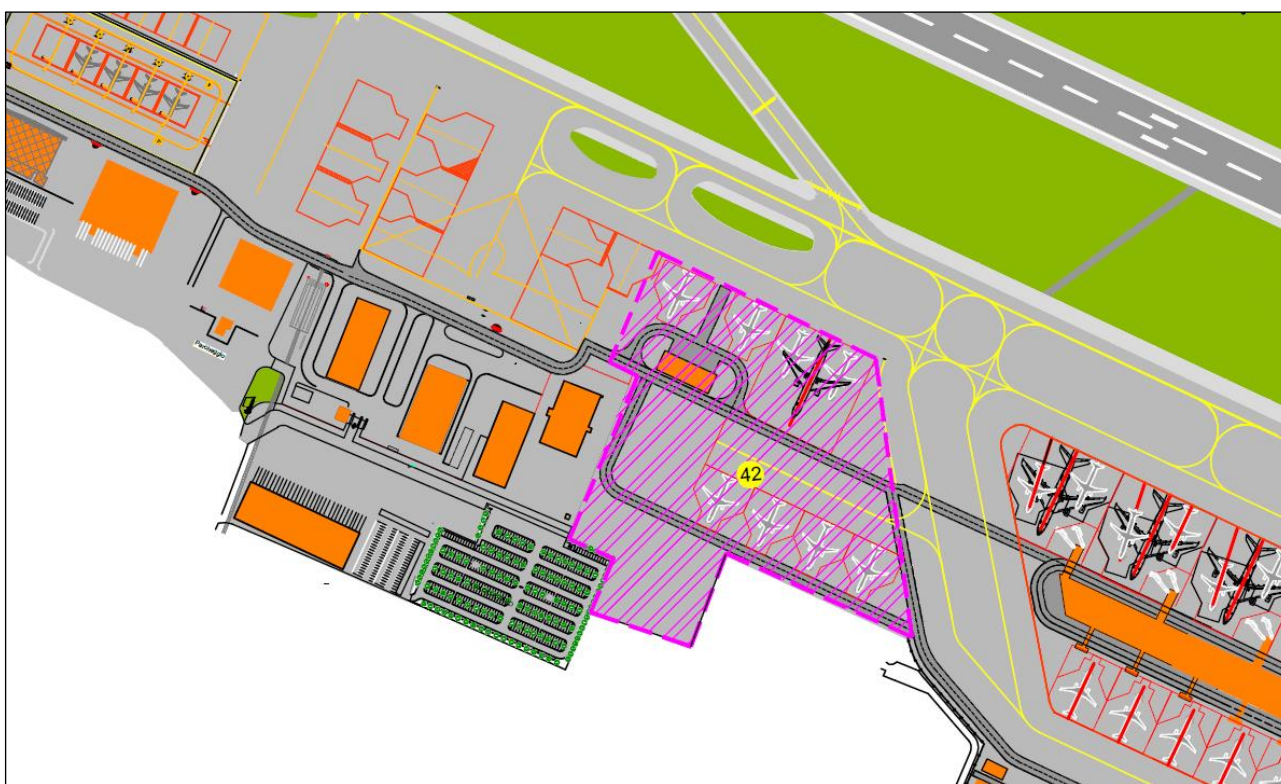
Estratto Master Plan – Ampliamento Apron 2
